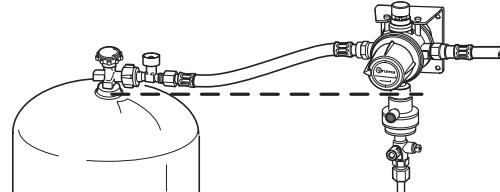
Tutte le dimensioni sono espresse in mm.
